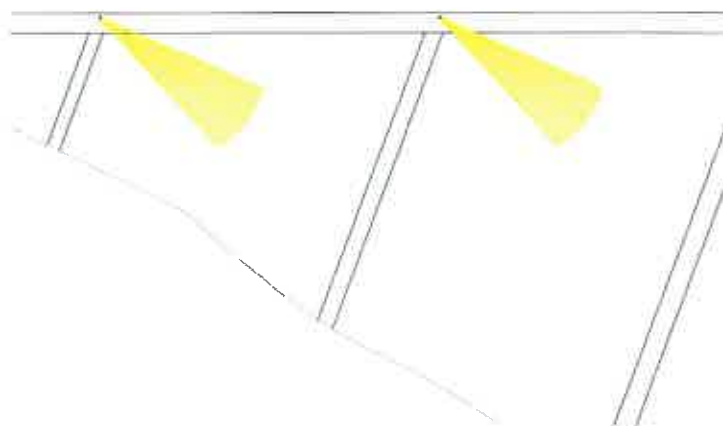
Alçado longitudinal parcial da Ponte, com localização dos projectores sob o tabuleiro
